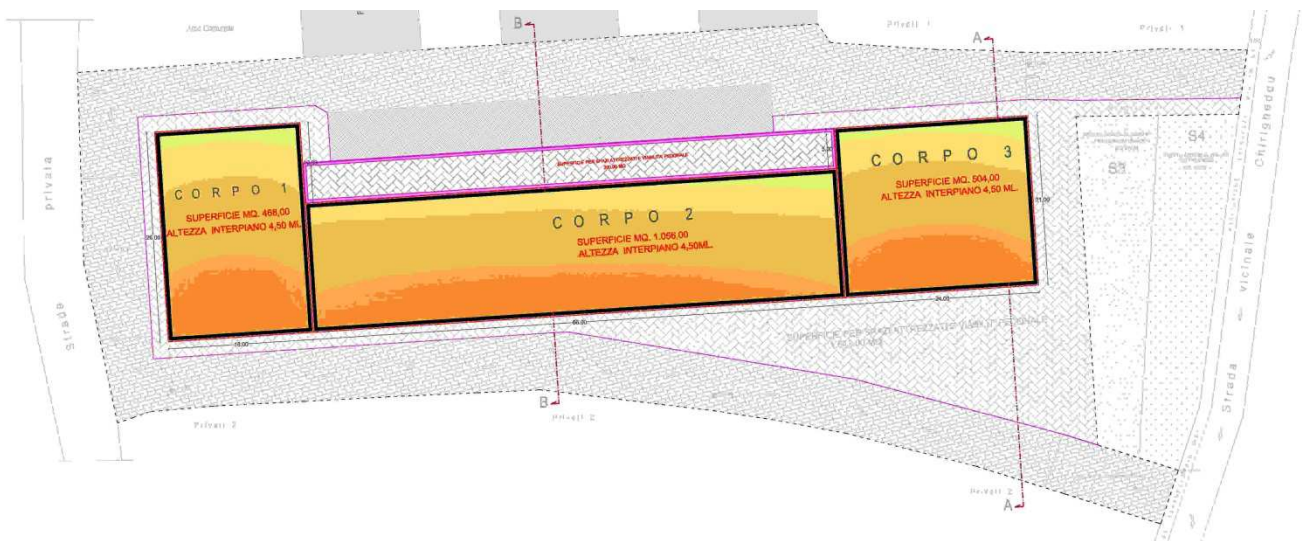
Planimetria della lottizzazione – Stato di progetto (rif. Tav. 5)
